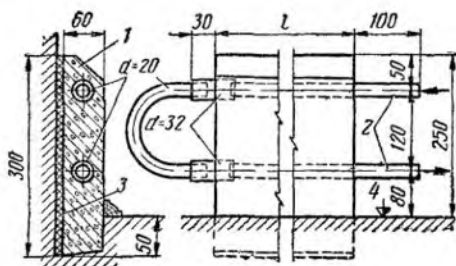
Плитусная приставная бетонная отопительная панель
